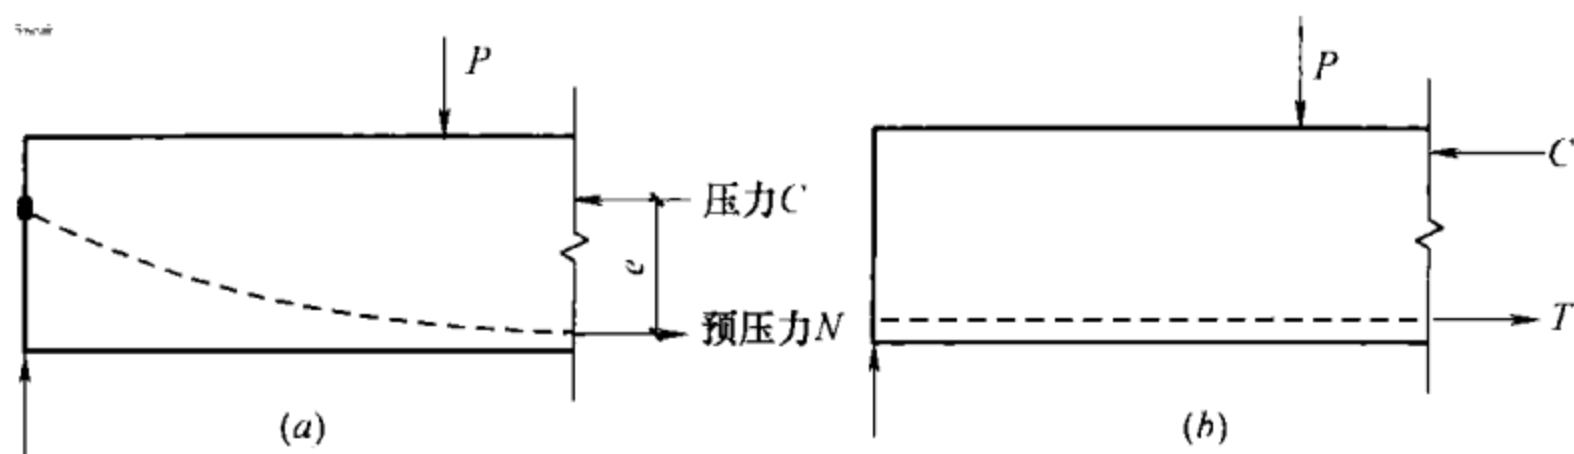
预应力混凝土梁与钢筋混凝土梁的内部抵抗力矩
